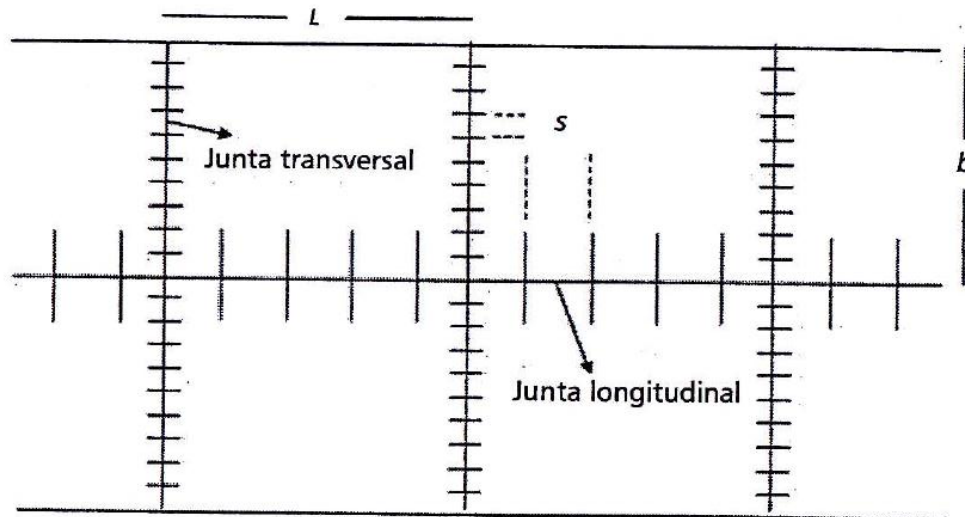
Vista de planta típica de una losa de pavimento rígido con junta con pasadores y barras de anclaje
